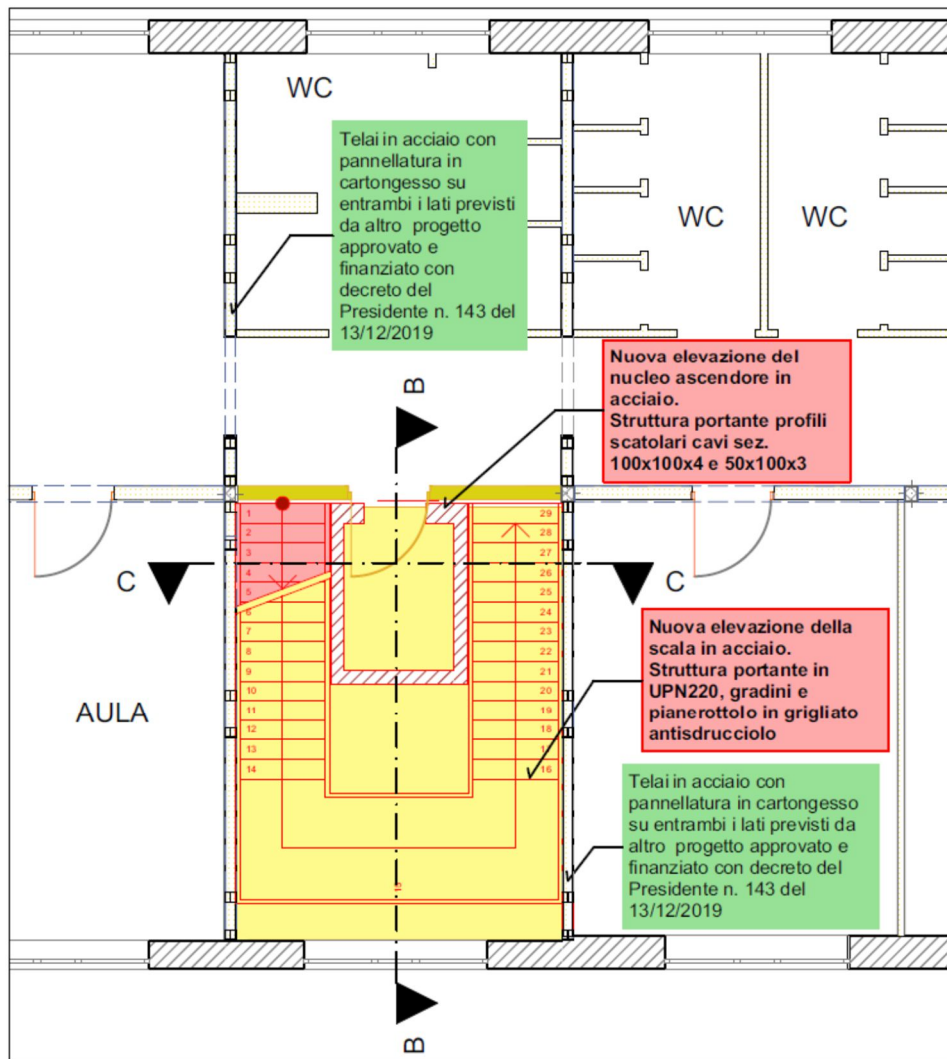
Sopraelevazione scala interna: pianta piano terzo
